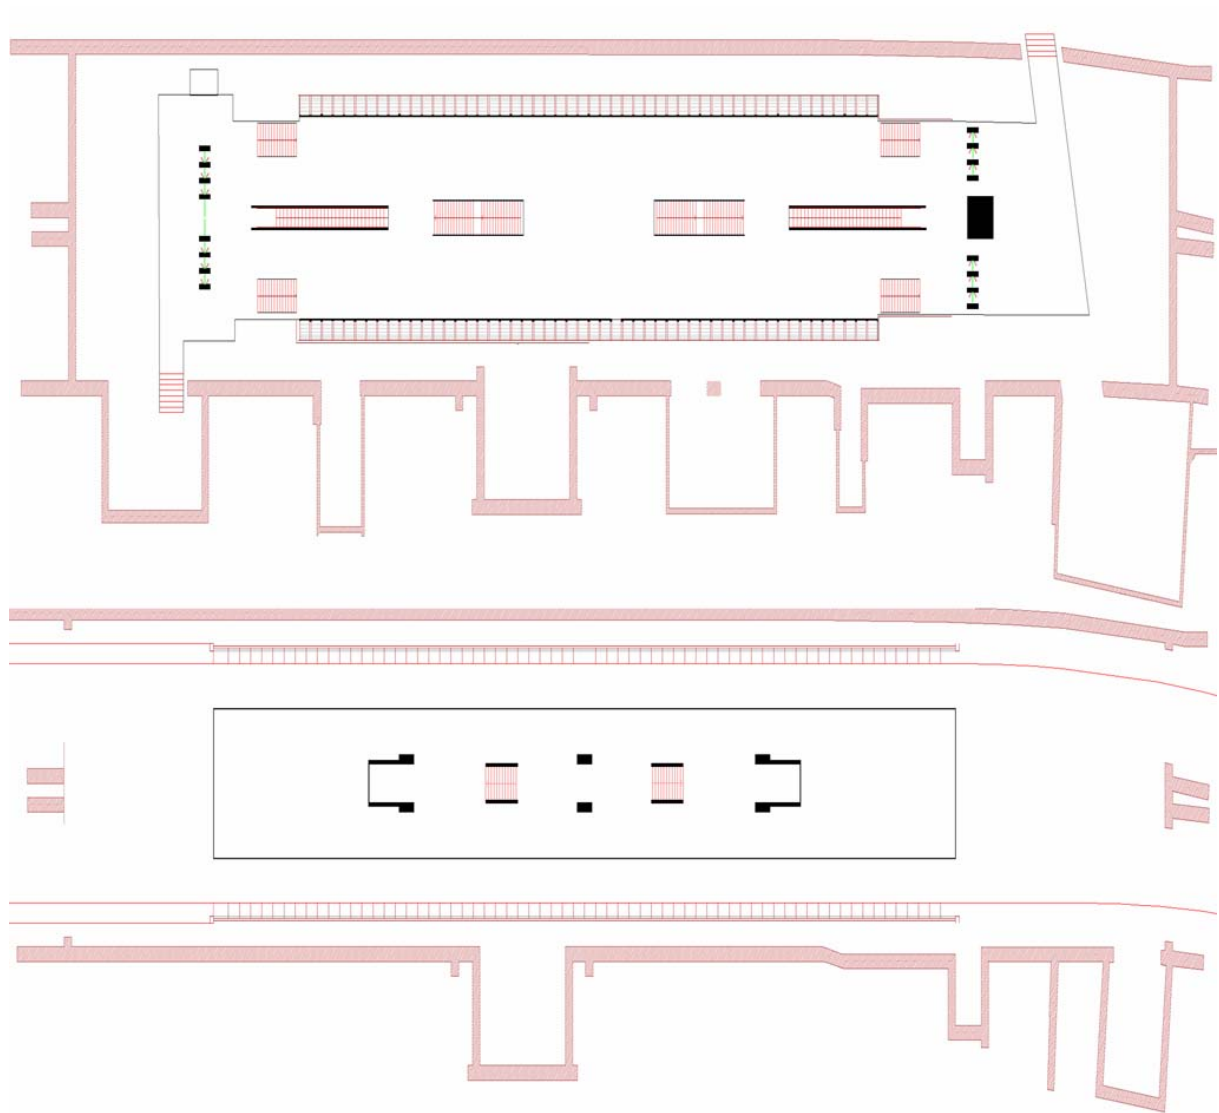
Parte della planimetria della stazione Darsena a Genova
